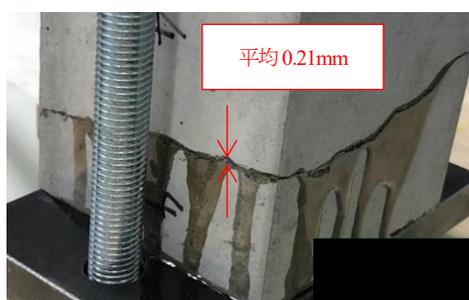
No.2 供試体（ひび割れ幅 0.21mm）
